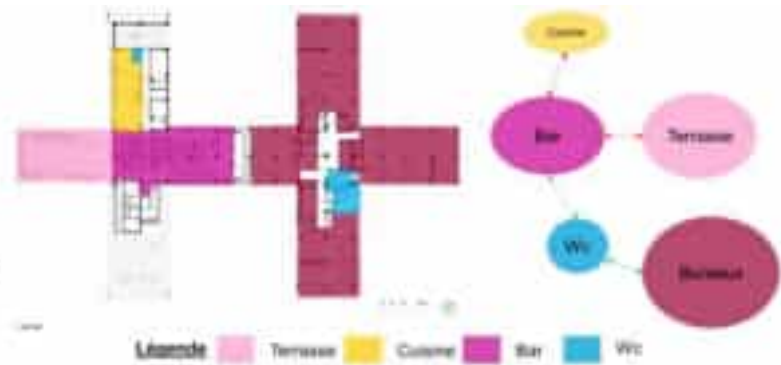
Plan de terrasse des tours du complexe Sétif park mall / Source : auteur
